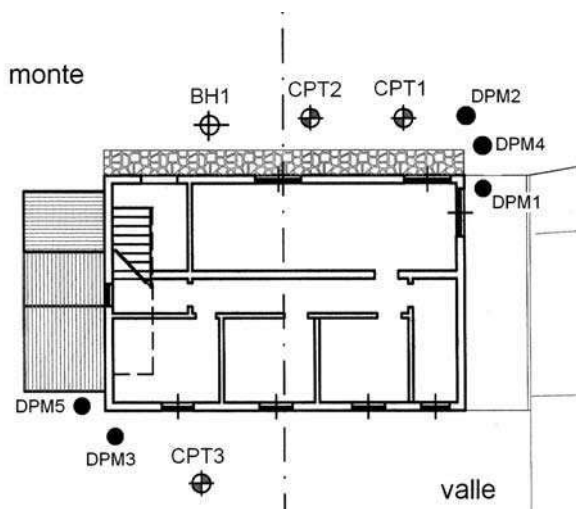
PLANIMETRIA DELL'EDIFICIO ED UBICAZIONE PROVE IN SITU
